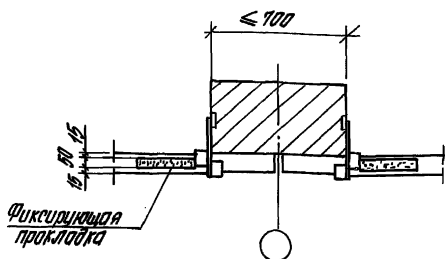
В поперечных перегородках у средних колонн здания с высотой сечения колонны ≤ 700 и у фак-верковых колонн
